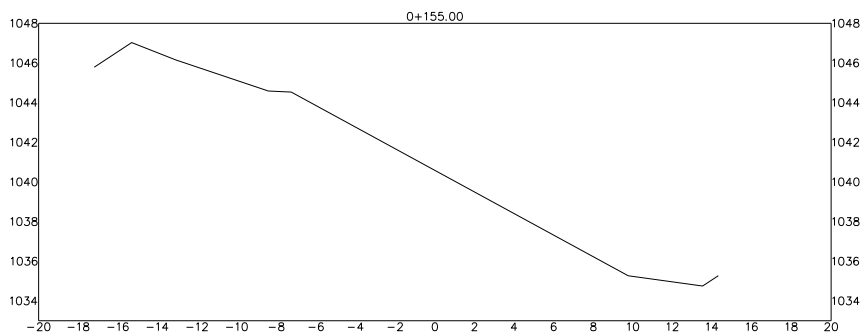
Sección transversal 0+155 de la zona del deslizamiento
